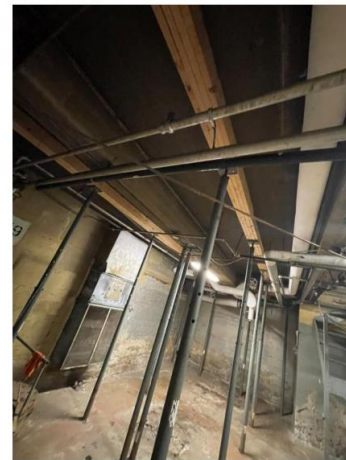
Vue du plafond du sous-sol avec étais temporaires sous les poutres
